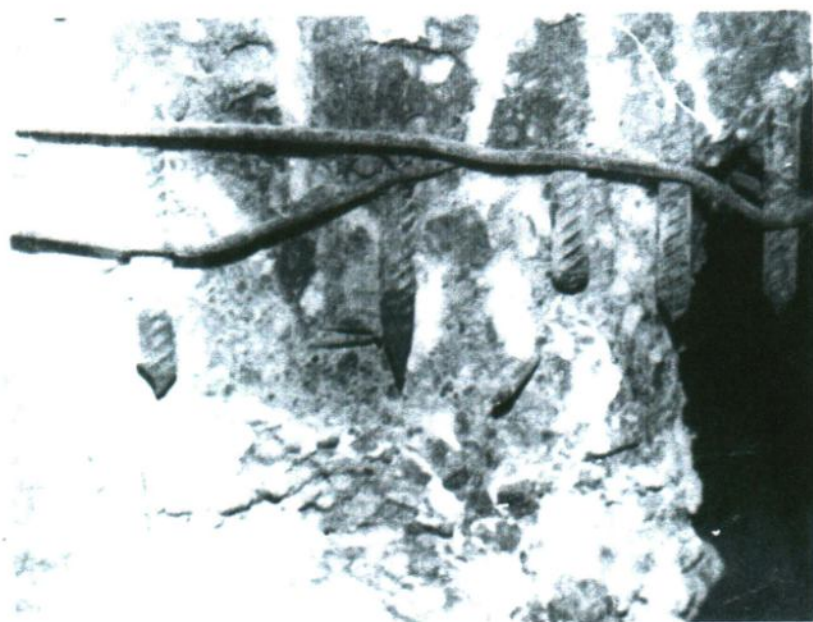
Degradarea betonului și a armăturii datorită acidului sulfuric la baza unui stâlp, sub pardoseală (situație descoperită prin sondaj efectuat la fundație).
